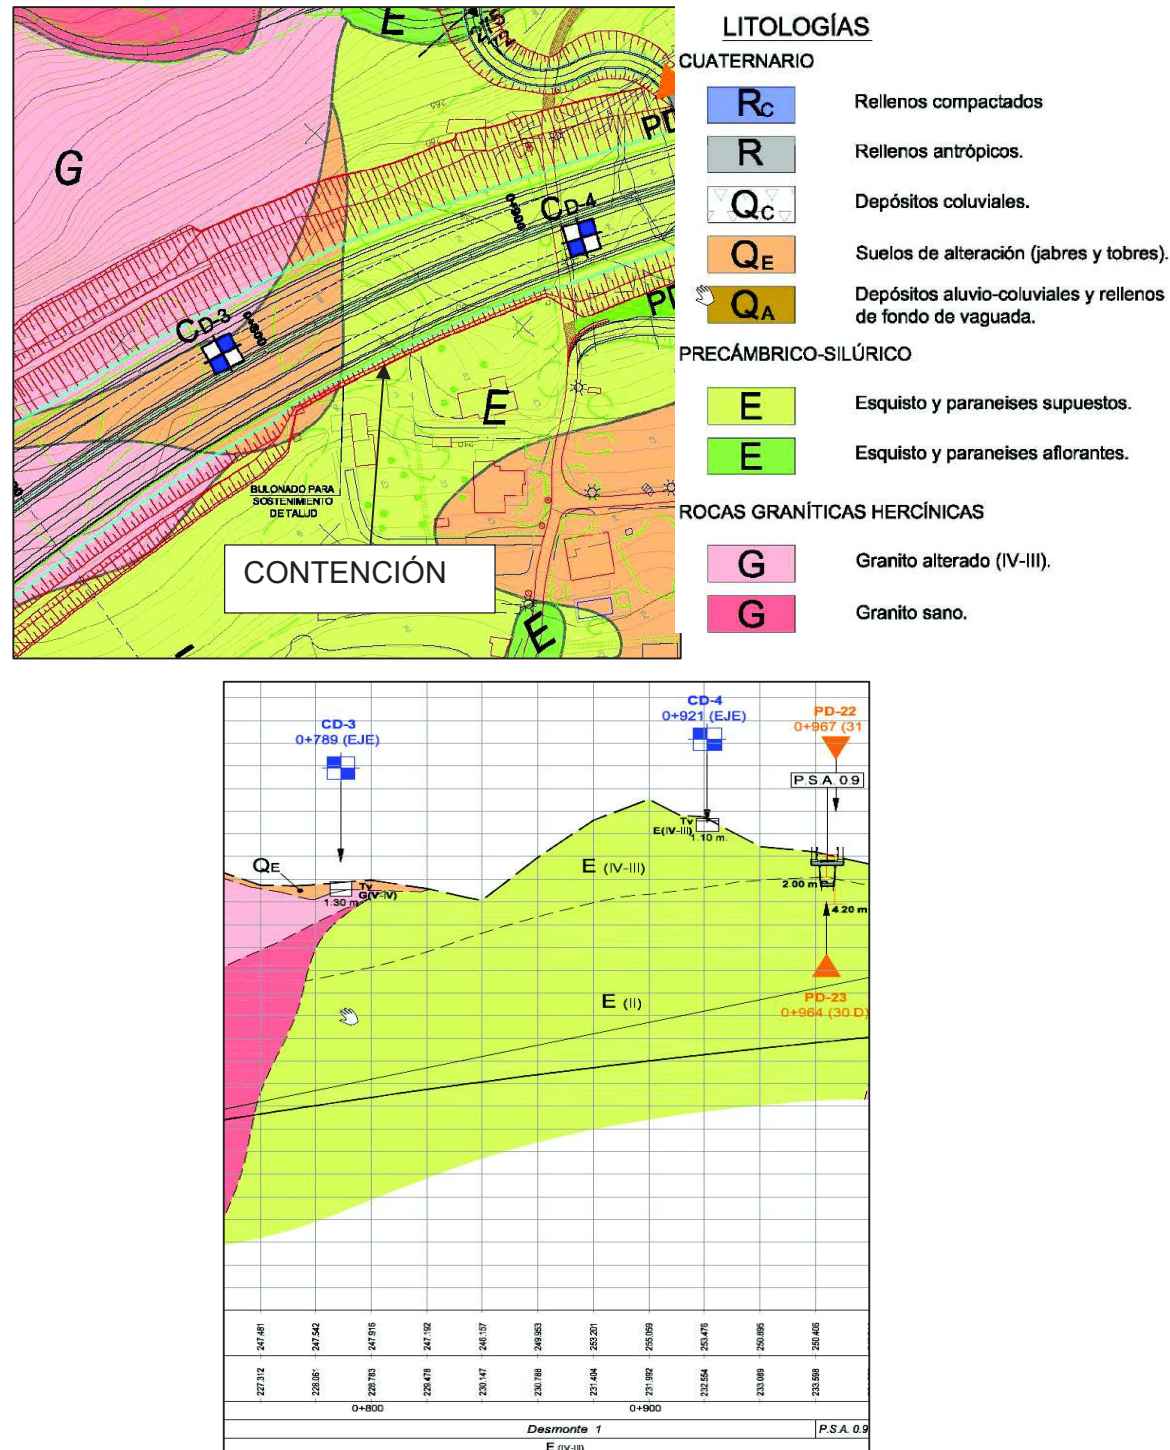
Planta y perfil geológico-geotécnico (Proyecto de Construcción)
